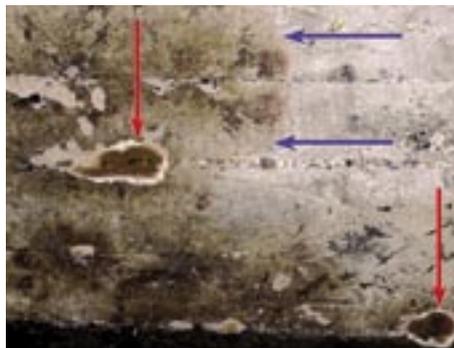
Neuer Auswuchs von Fruchtkörpern des Echten Hausschwammes (↑) an einer Betondecke; Spuren eines entfernten Fruchtkörpers sind sichtbar (→).
